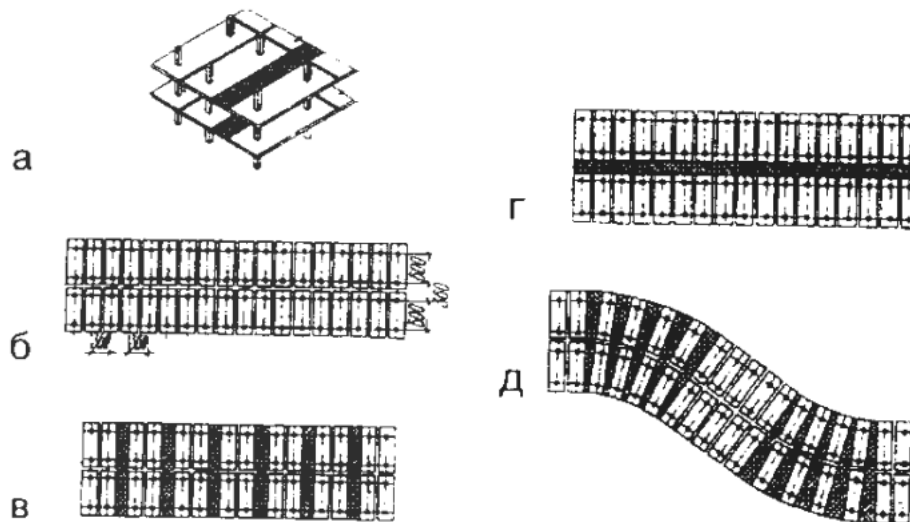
Каркасна система з плоским перекриттям: а – схема каркасу; б, в, г, д – варіанти монтажних схем
